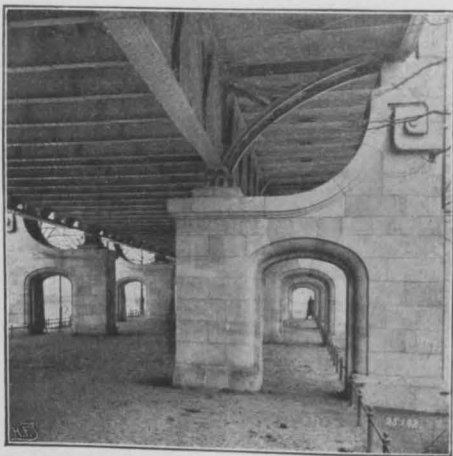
Durchsicht unter der Haltestelle Bülowstraße.
